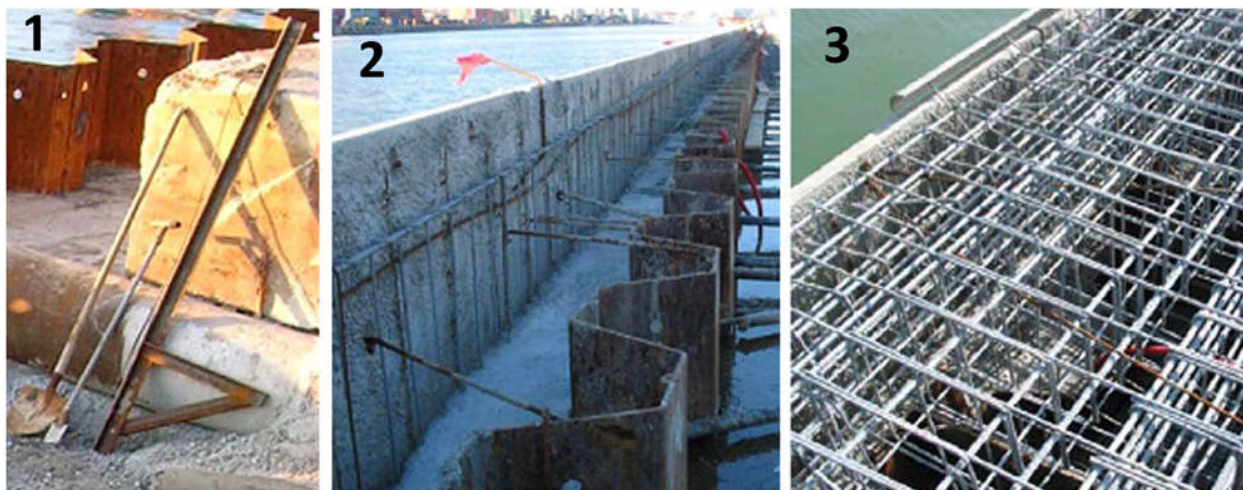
Sequenza di fissaggio delle casseforme prefabbricate alla palancolata
